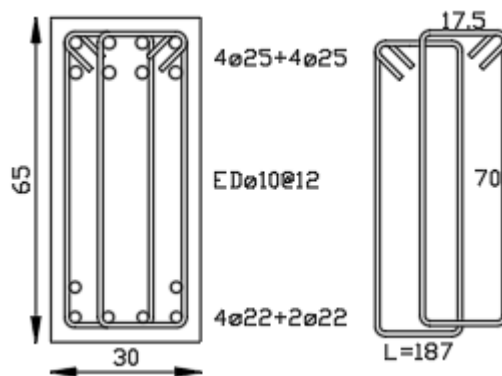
Vigas ejes 2 y 3, nivel 1-20. Edificio de 20 pisos.
